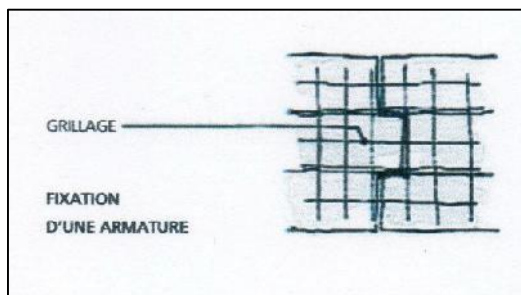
Fixation d'une armature sur la zone fissurée d'un mur en pierre
